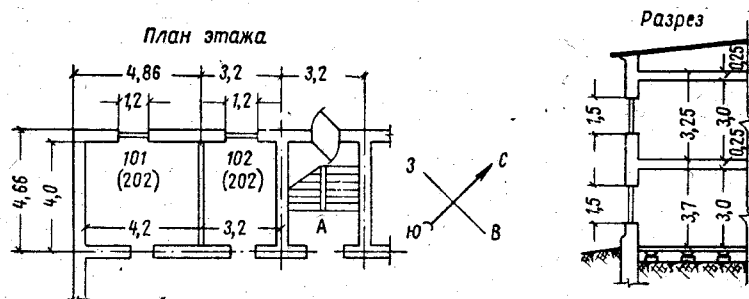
План и разрез здания к примеру расчета теплотерь
